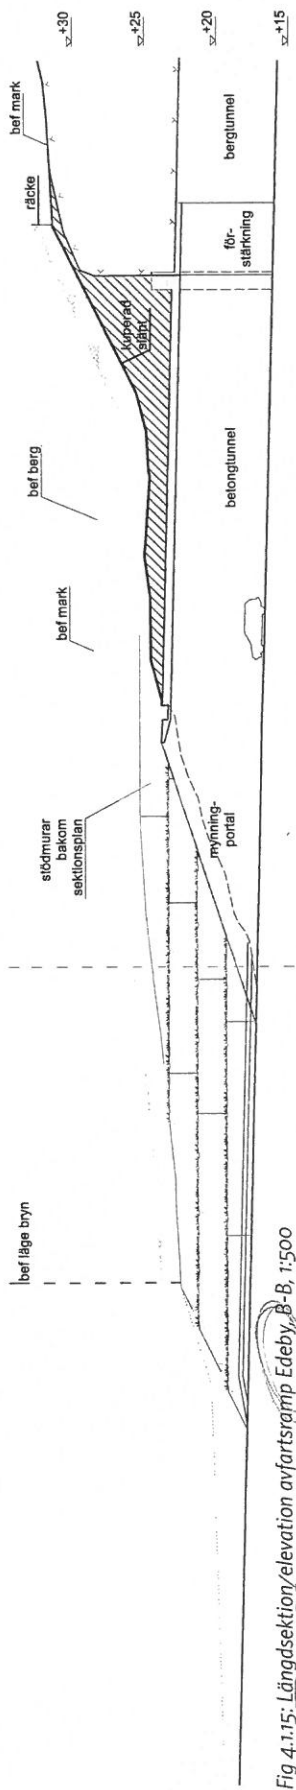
Längdsektion/elevation avfartsramp Edeby, B-B, 1:500.
